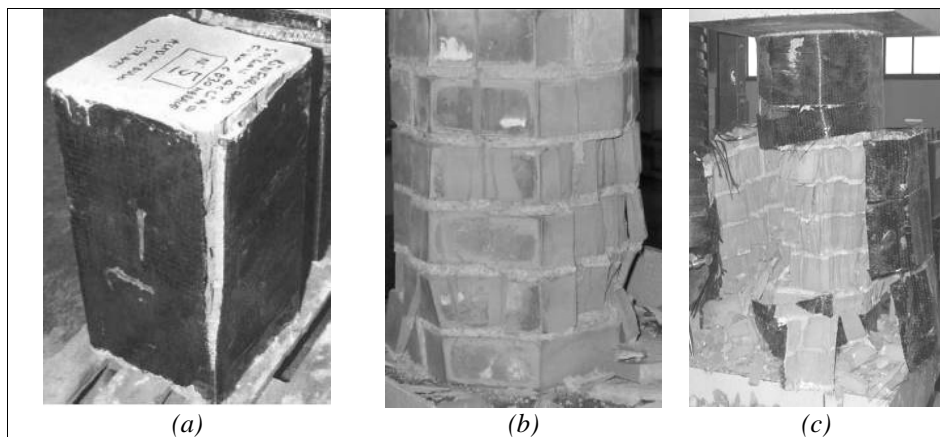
Rottura dei pilastri sottoposti a prova di compressione
